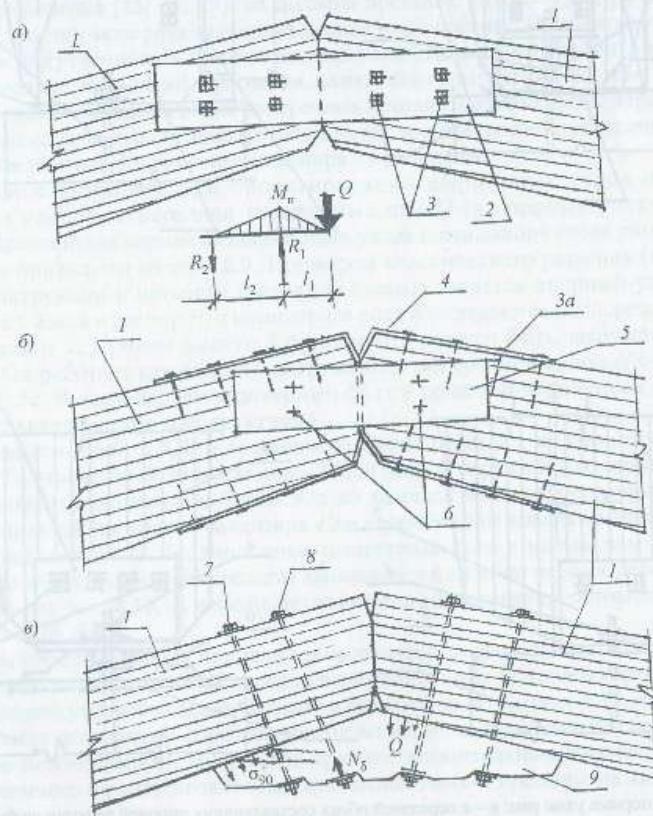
Конструкции коньковых узлов рам массового применения: а – на парных деревянных накладках 2 и двухсрезных болтах 3; б – на металлических пластинках Z-образной формы 4 и односрезных нагелях 3а; в – на болтах 7 и 8 и подкладке 9; 1 – коньковые части ригелей полурам; 5 – срезные нагели; 6 – накладки и болты, устанавливаемые конструктивно
